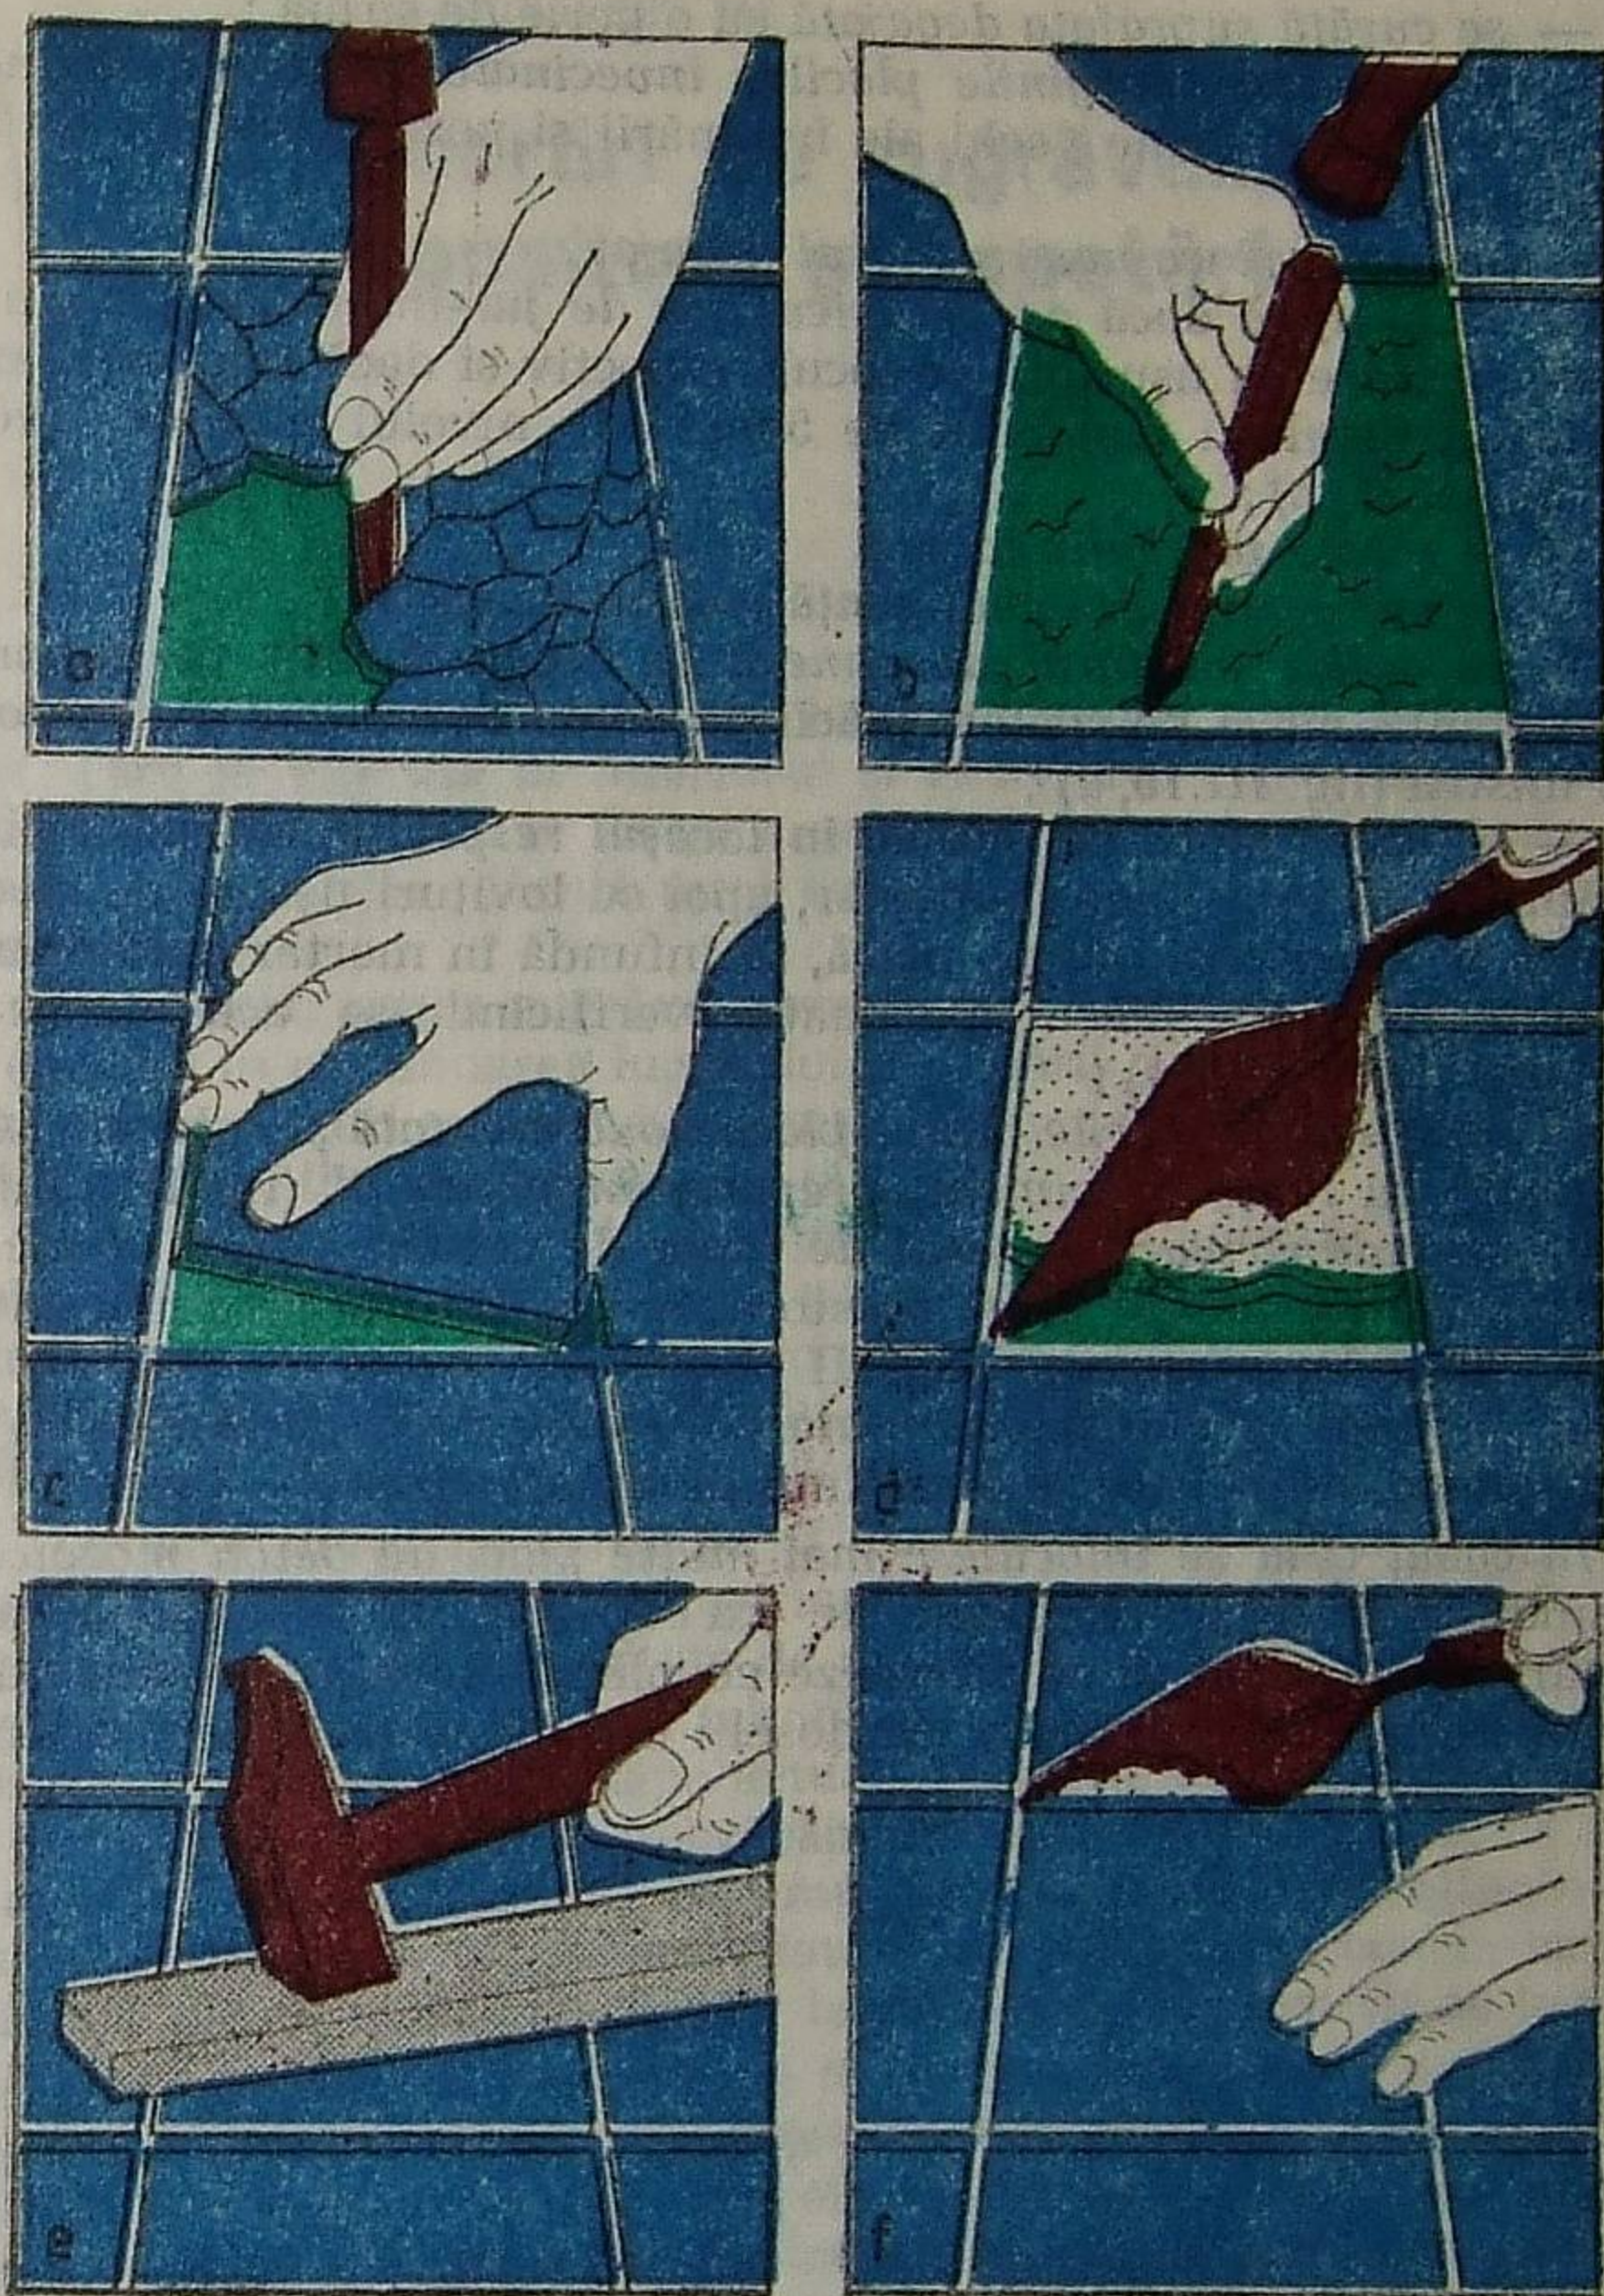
Cum se înlocuiește o placă de beton mozaică :
